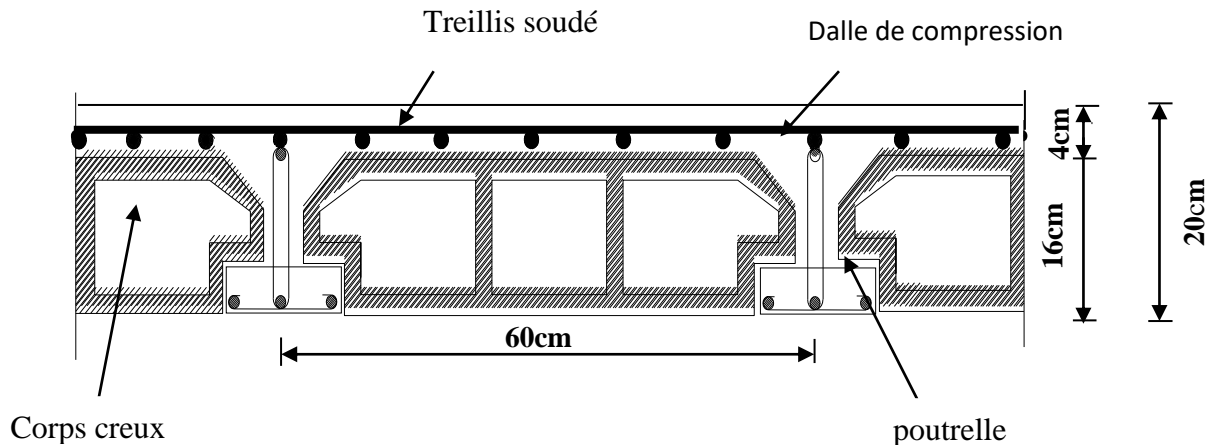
Coupe Verticale d'un Plancher en Corps Creux
